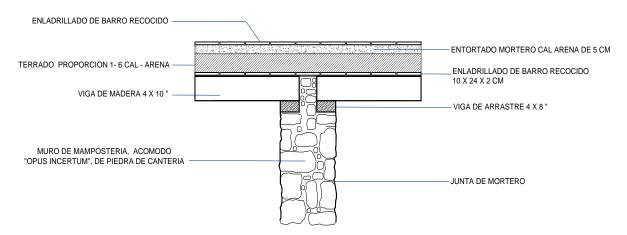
Detalle No. 3 vista de corte de la cubierta mostrando la viguería, el enladrillado y el terrado.
